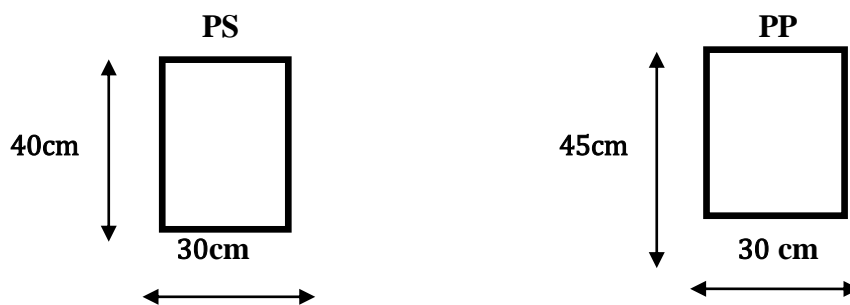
Les dimensions de la poutre principale et la poutre secondaire.
